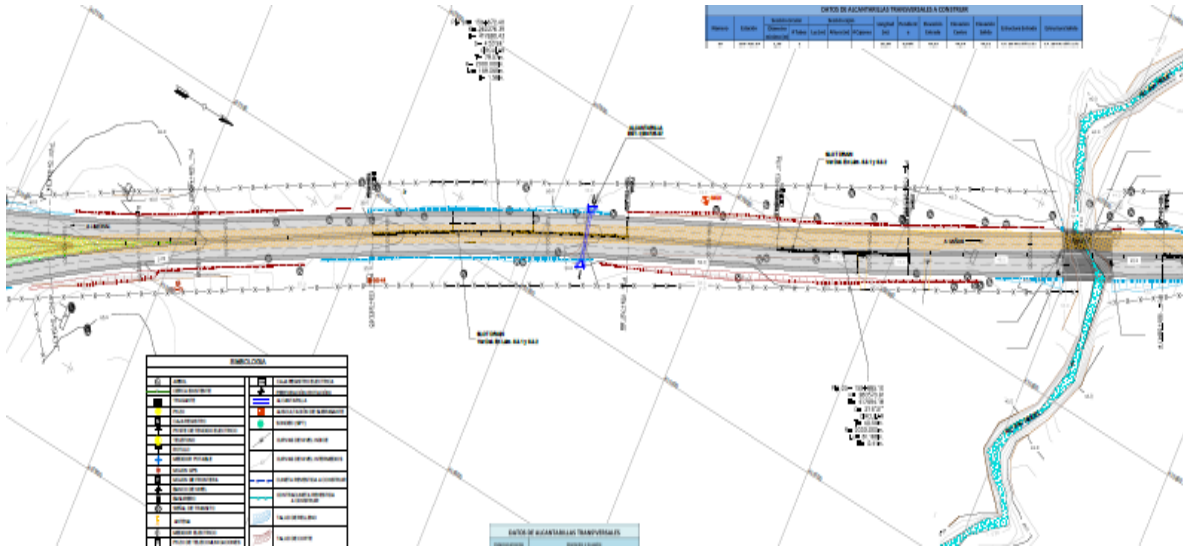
Planta de perfil (estación kilometraje 159+400 – 160+100)
